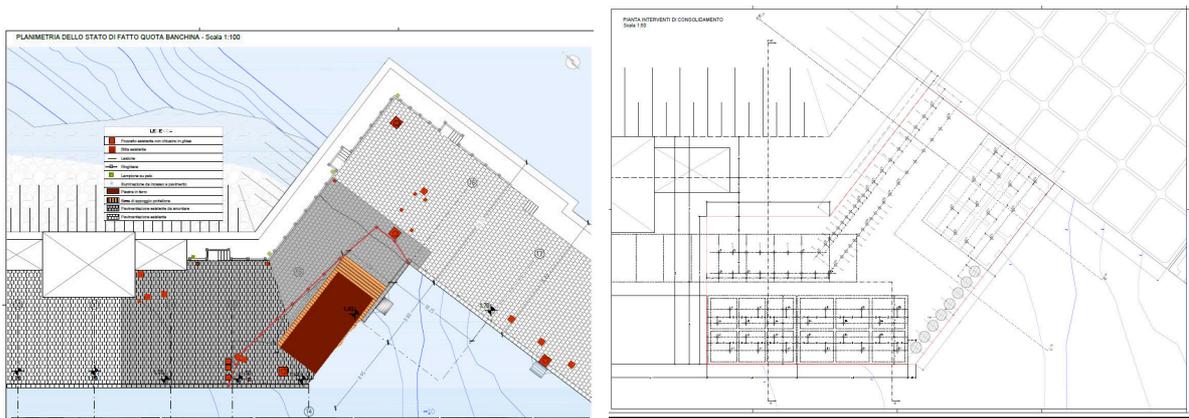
Planimetria stato di fatto, con evidenziate lesioni sulla pavimentazione, linea di delimitazione area dissesto, piastra in ferro e relativa base di appoggio e planimetria stato di progetto con interventi di paratia di pali $\phi 800$ a filo banchina e micropali a tergo
